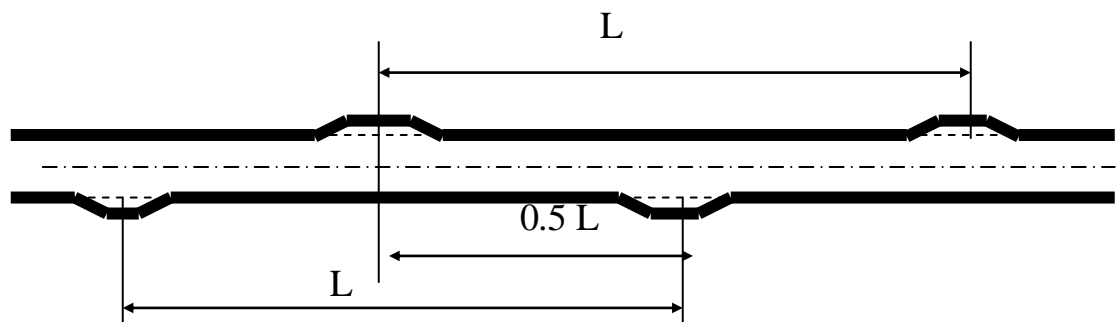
Схема расположения на двухполосной дороге площадок для аварийной остановки автомобилей где L - расчетное расстояние между площадками
